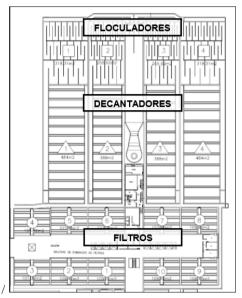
Planta baixa ETA n°1 do complexo da ETA Laranjal Fonte: Silva (2015) – adaptado do arquivo da CEDAE
